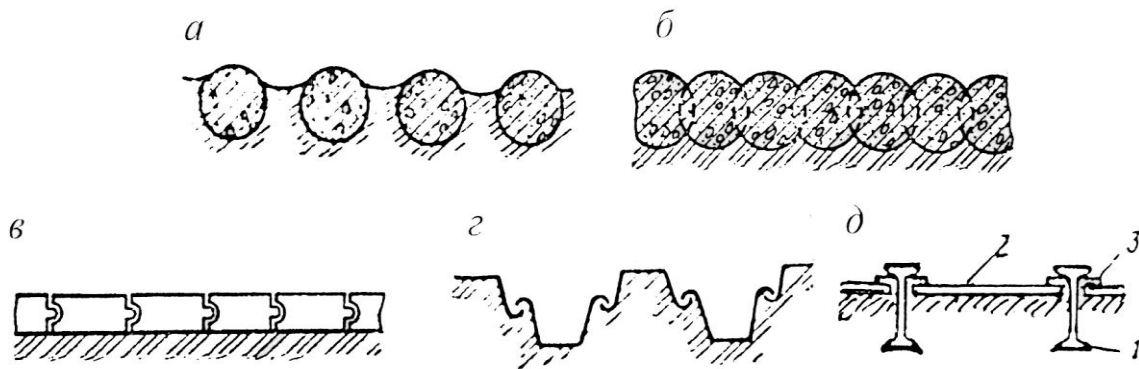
Обгороджувальні конструкції стін (котлованів): а – буронабивні палі; б – залізобетонна стінка з паль; в – залізобетонний шпунт; г – металевий шпунт; д – прокатний профіль; 1 – двотавр; 2 – обгородження з дощок; 3 – рейка
